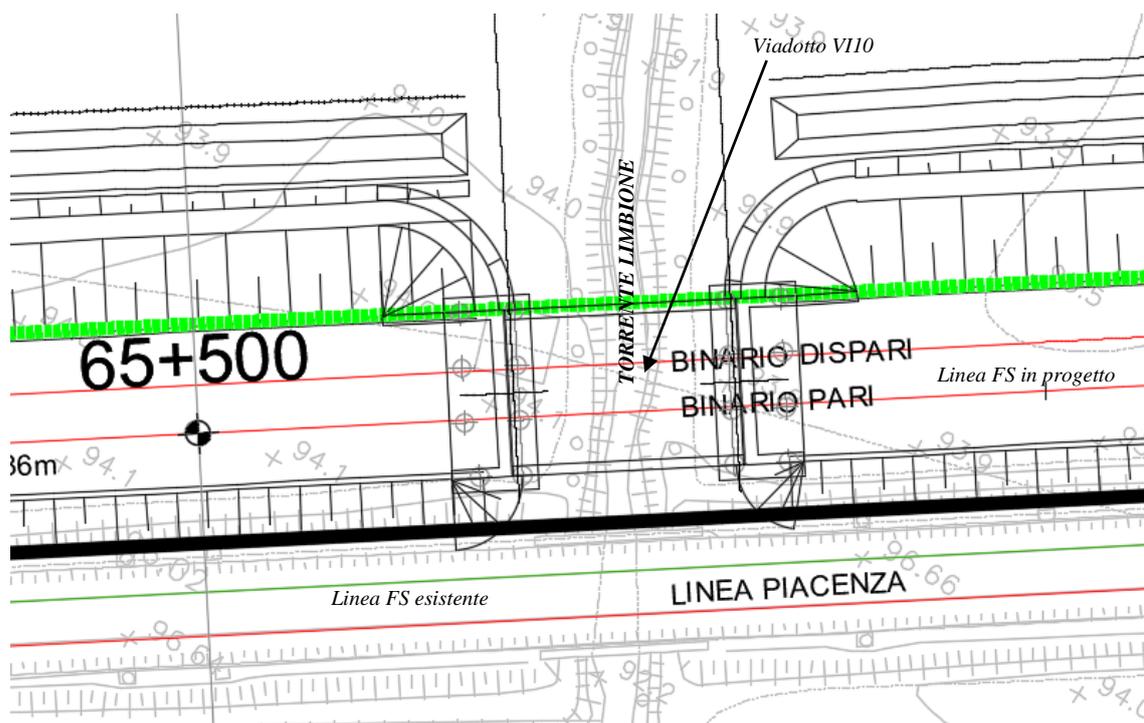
Torrente Limbione: pianta dell'opera di attraversamento in progetto
